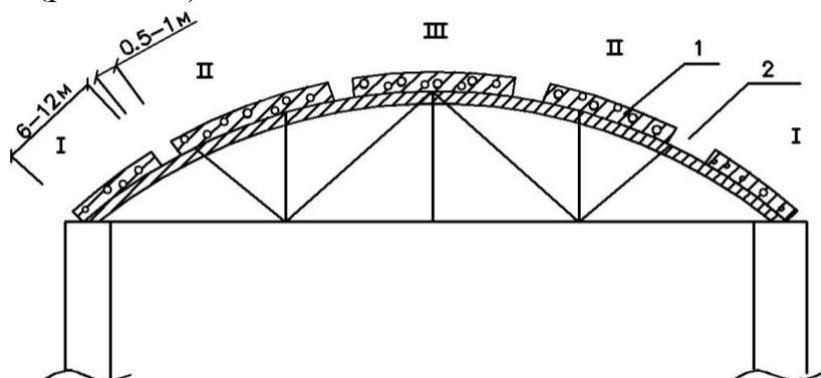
Бетонирование сводов и арок пролётом более 15 м:
